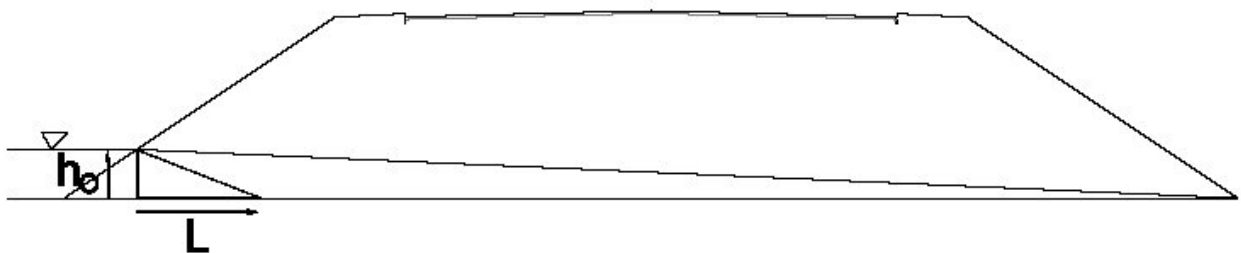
Schema di riempimento del rilevato stradale (sezione 327).
